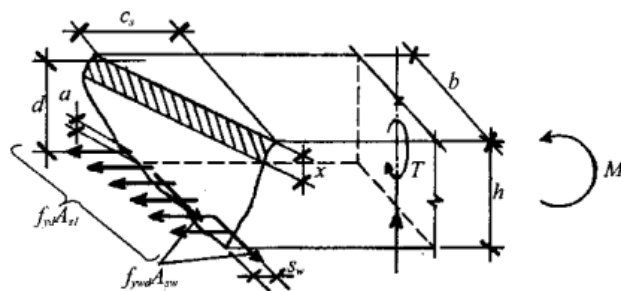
Схема зусиль у просторовому перерізі залізобетонного елемента, що працює на крученні зі згином, для розрахунку перерізу на міцність
